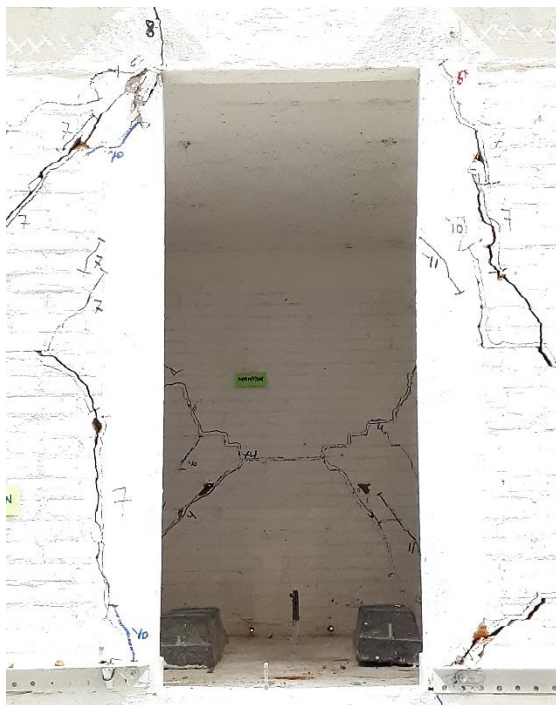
Estado final de daño en muros esbeltos de primer nivel en fachada sur (eje C)
